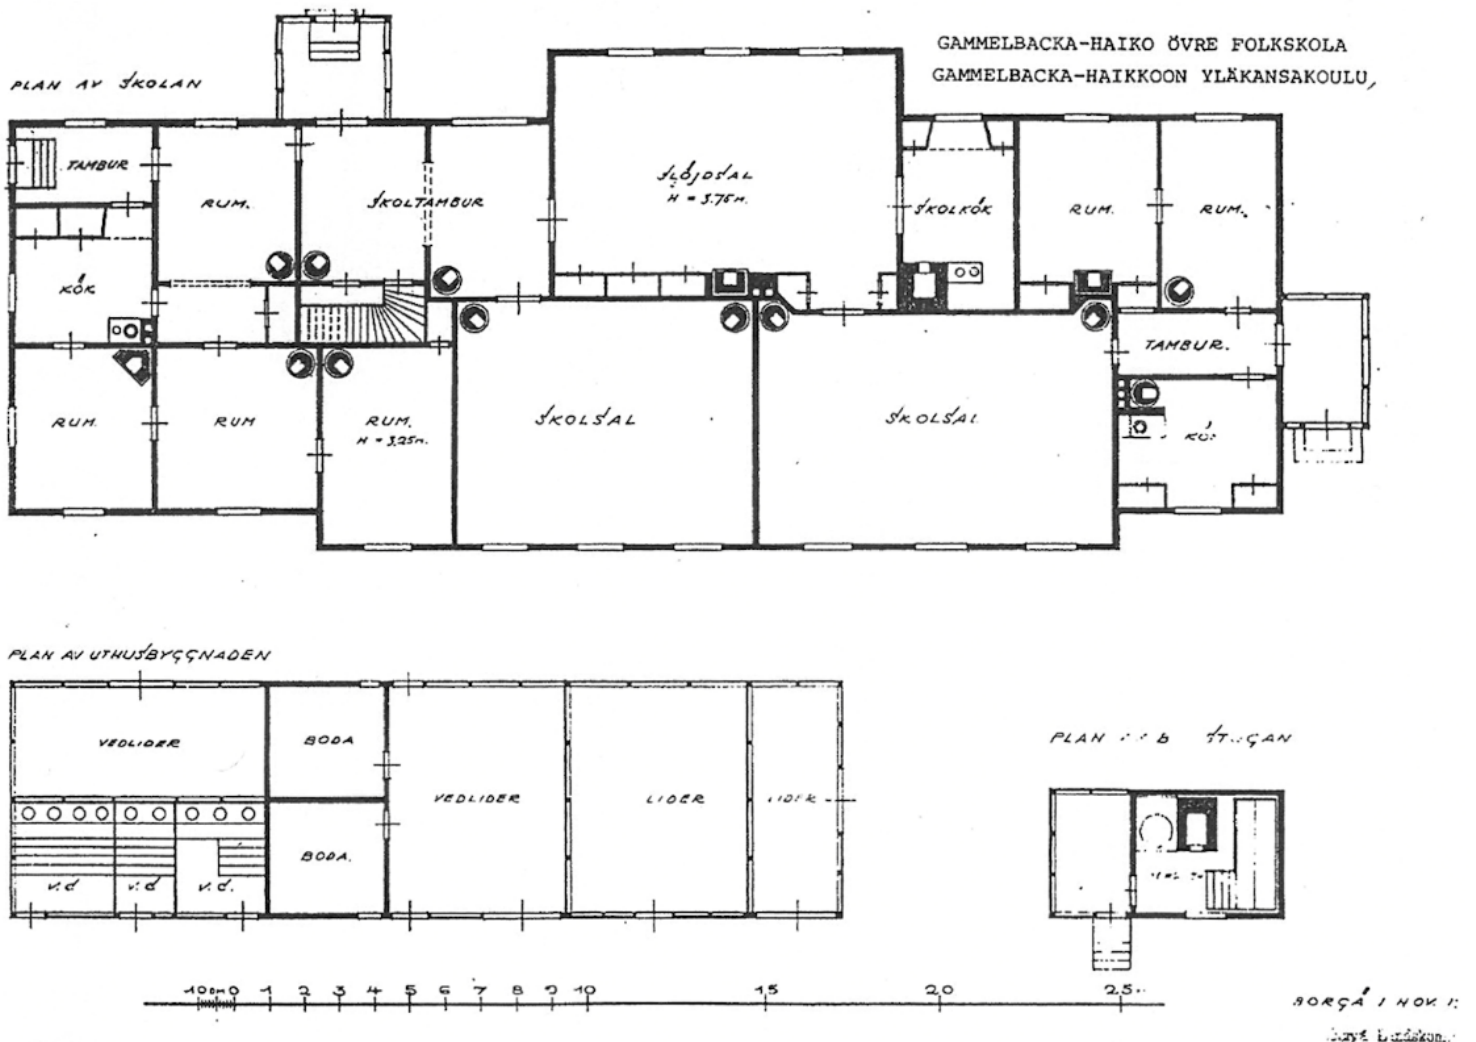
Den ursprungliga planritningen för Gammelbacka skola. (Källa: Hammars – Porten till havet, 1996.)
